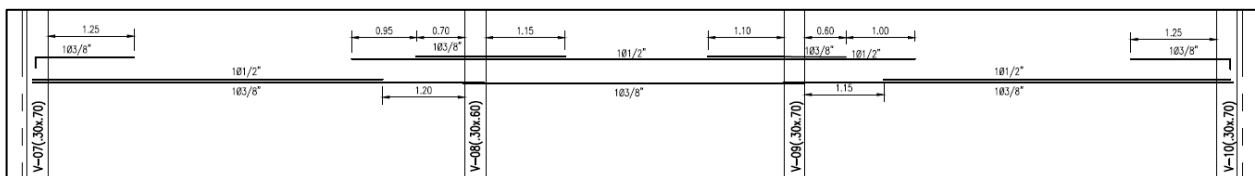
Distribución final del refuerzo en la losa aligerada analizada.
